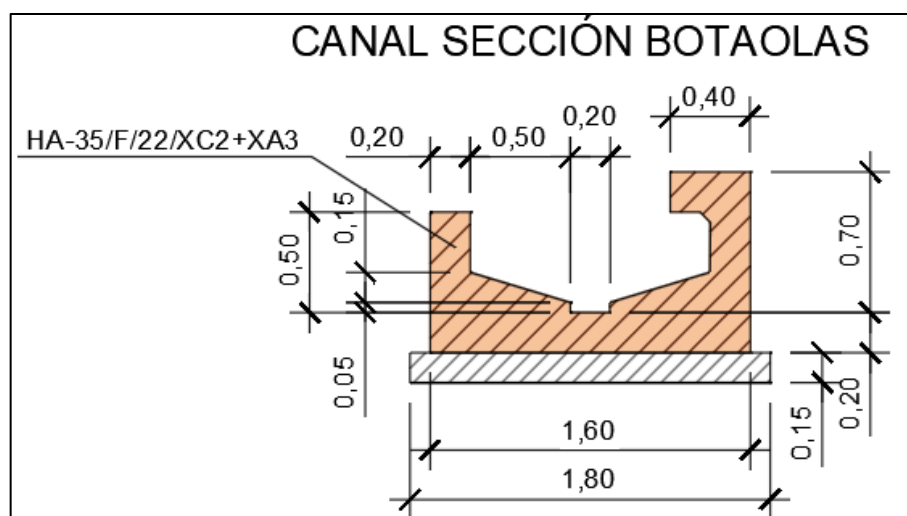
Sección tipo de cuneta de drenaje con botaolas.
